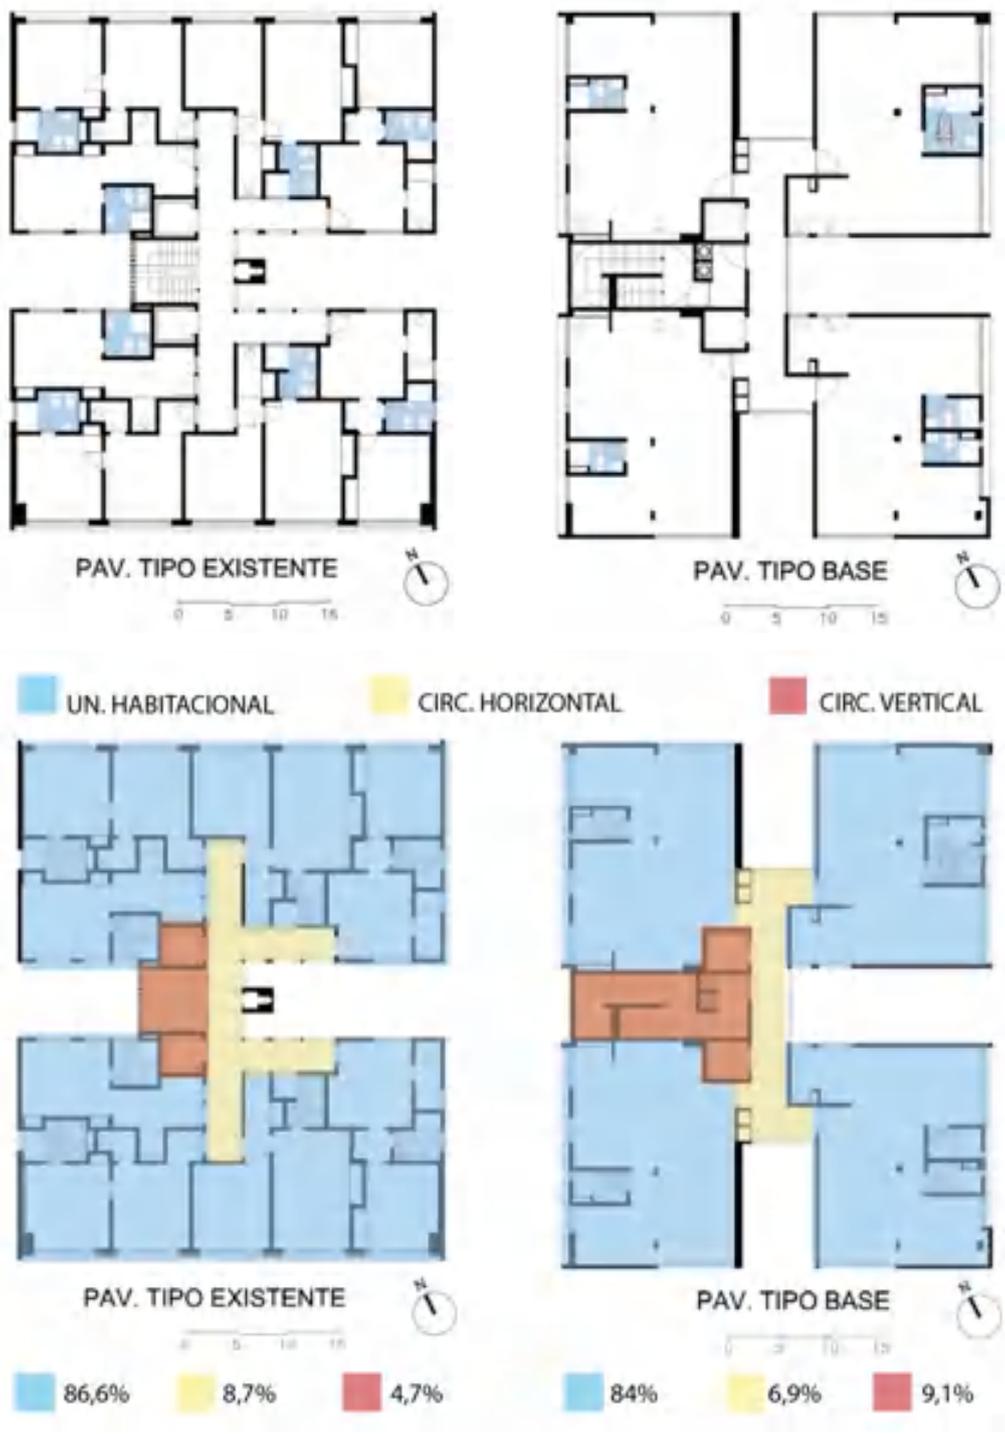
Zoneamento das Plantas Baixas do Pavimento Tipo. Situação Atual e Proposta.
